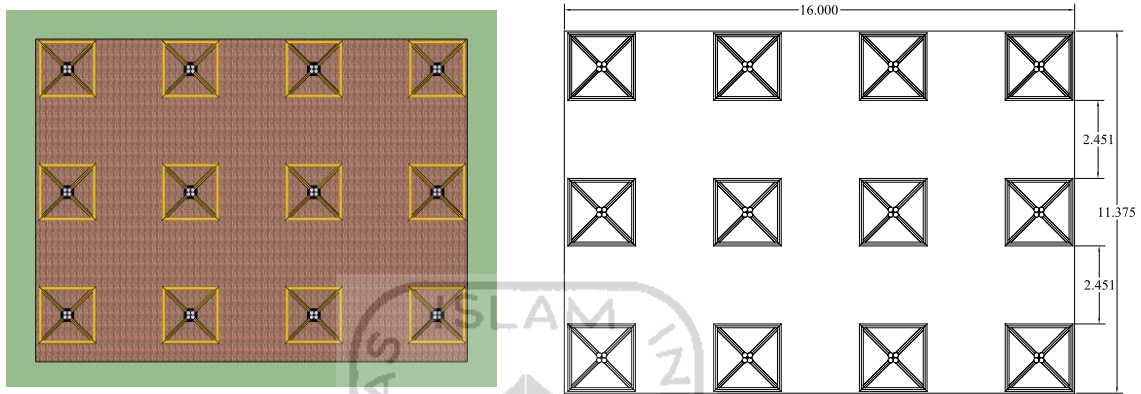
Potongan Arena Lomba Burung Berkicau
